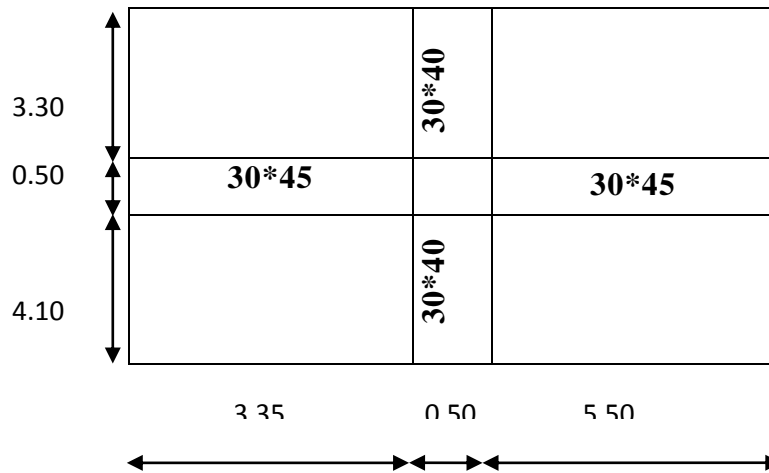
Représentation du poteau de centre le plus sollicité.
